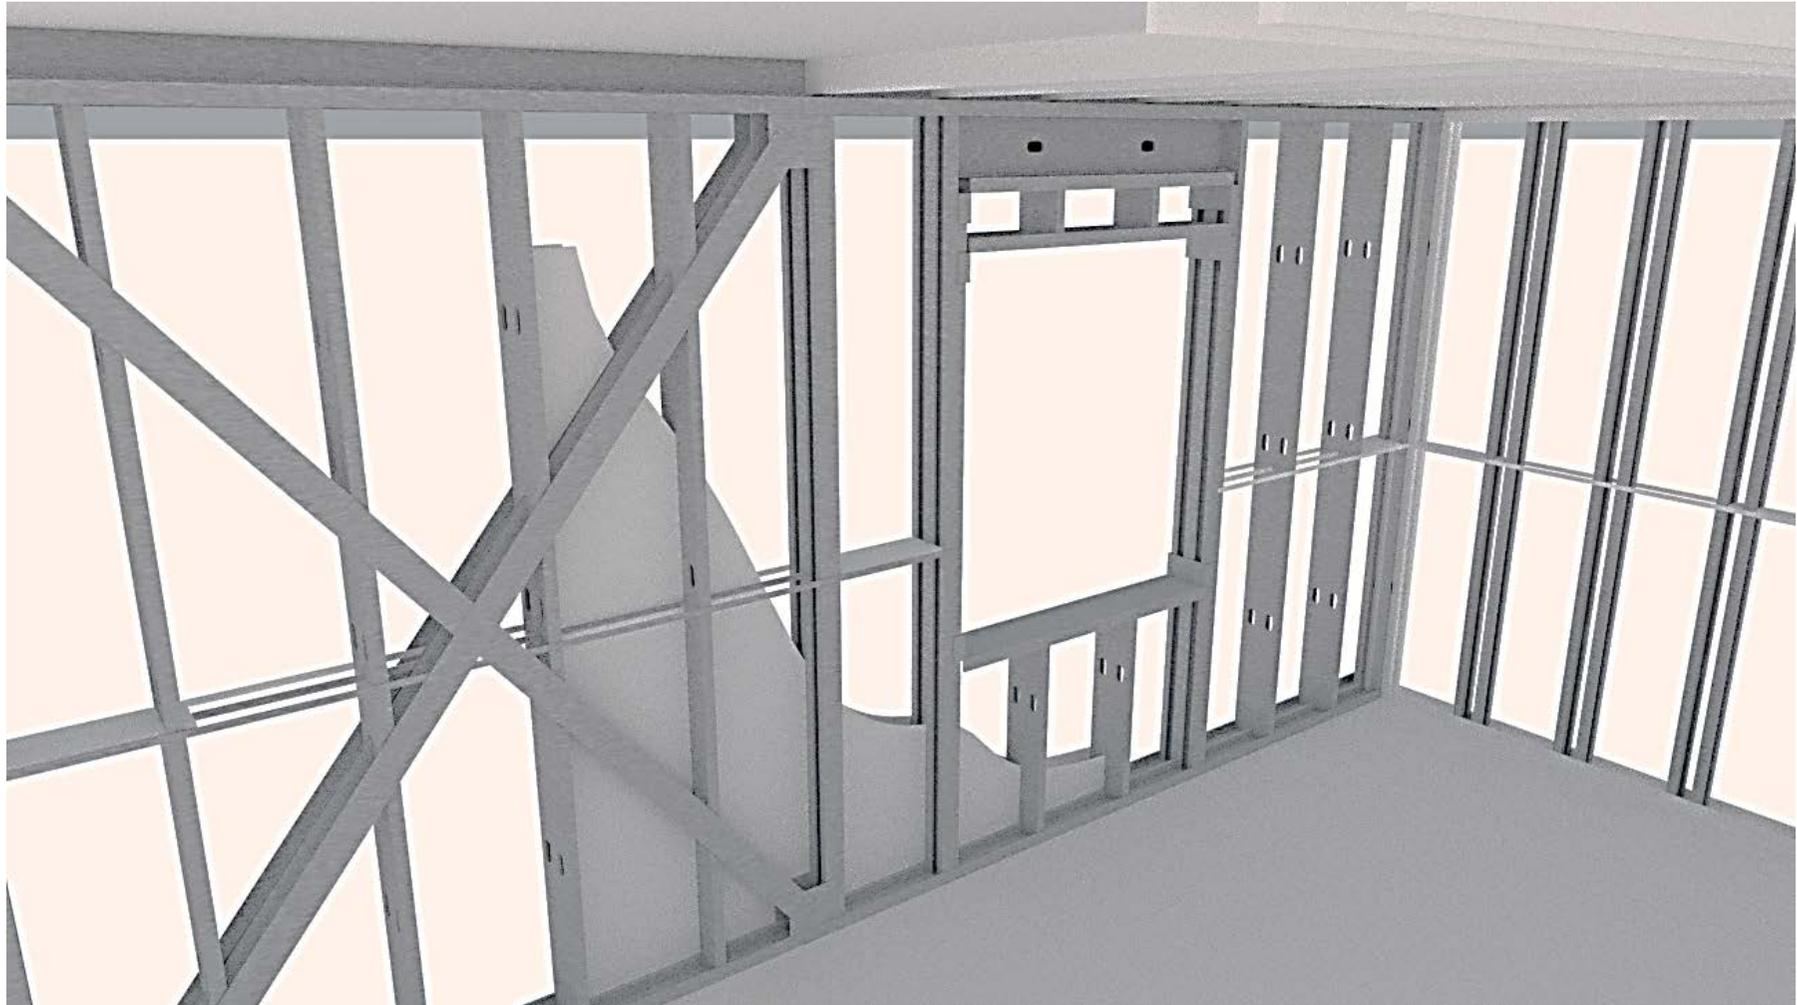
Andino, E. (2020)*. Vista detalle desde el interior. Elaboración propia.
